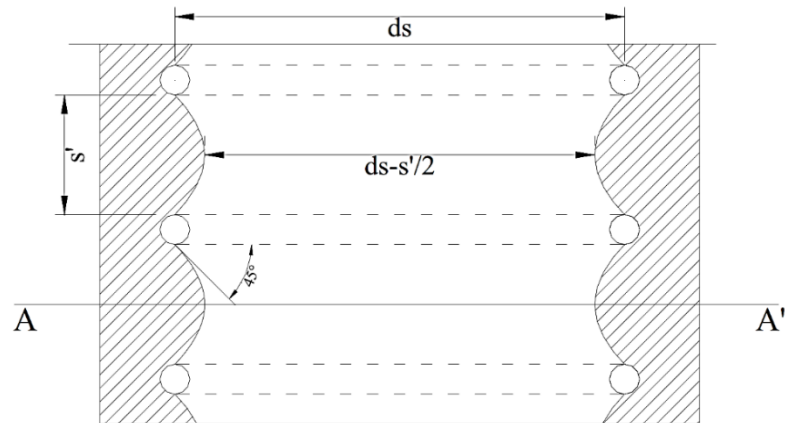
Efeito de arqueamento na direção longitudinal (MANDER; PRIESTLEY; PARK, 1988a)
